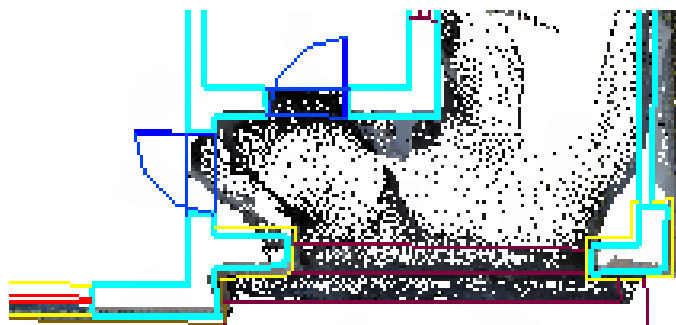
Comparação da planta baixa e fachada (medição direta) com a "nuvem de pontos"
